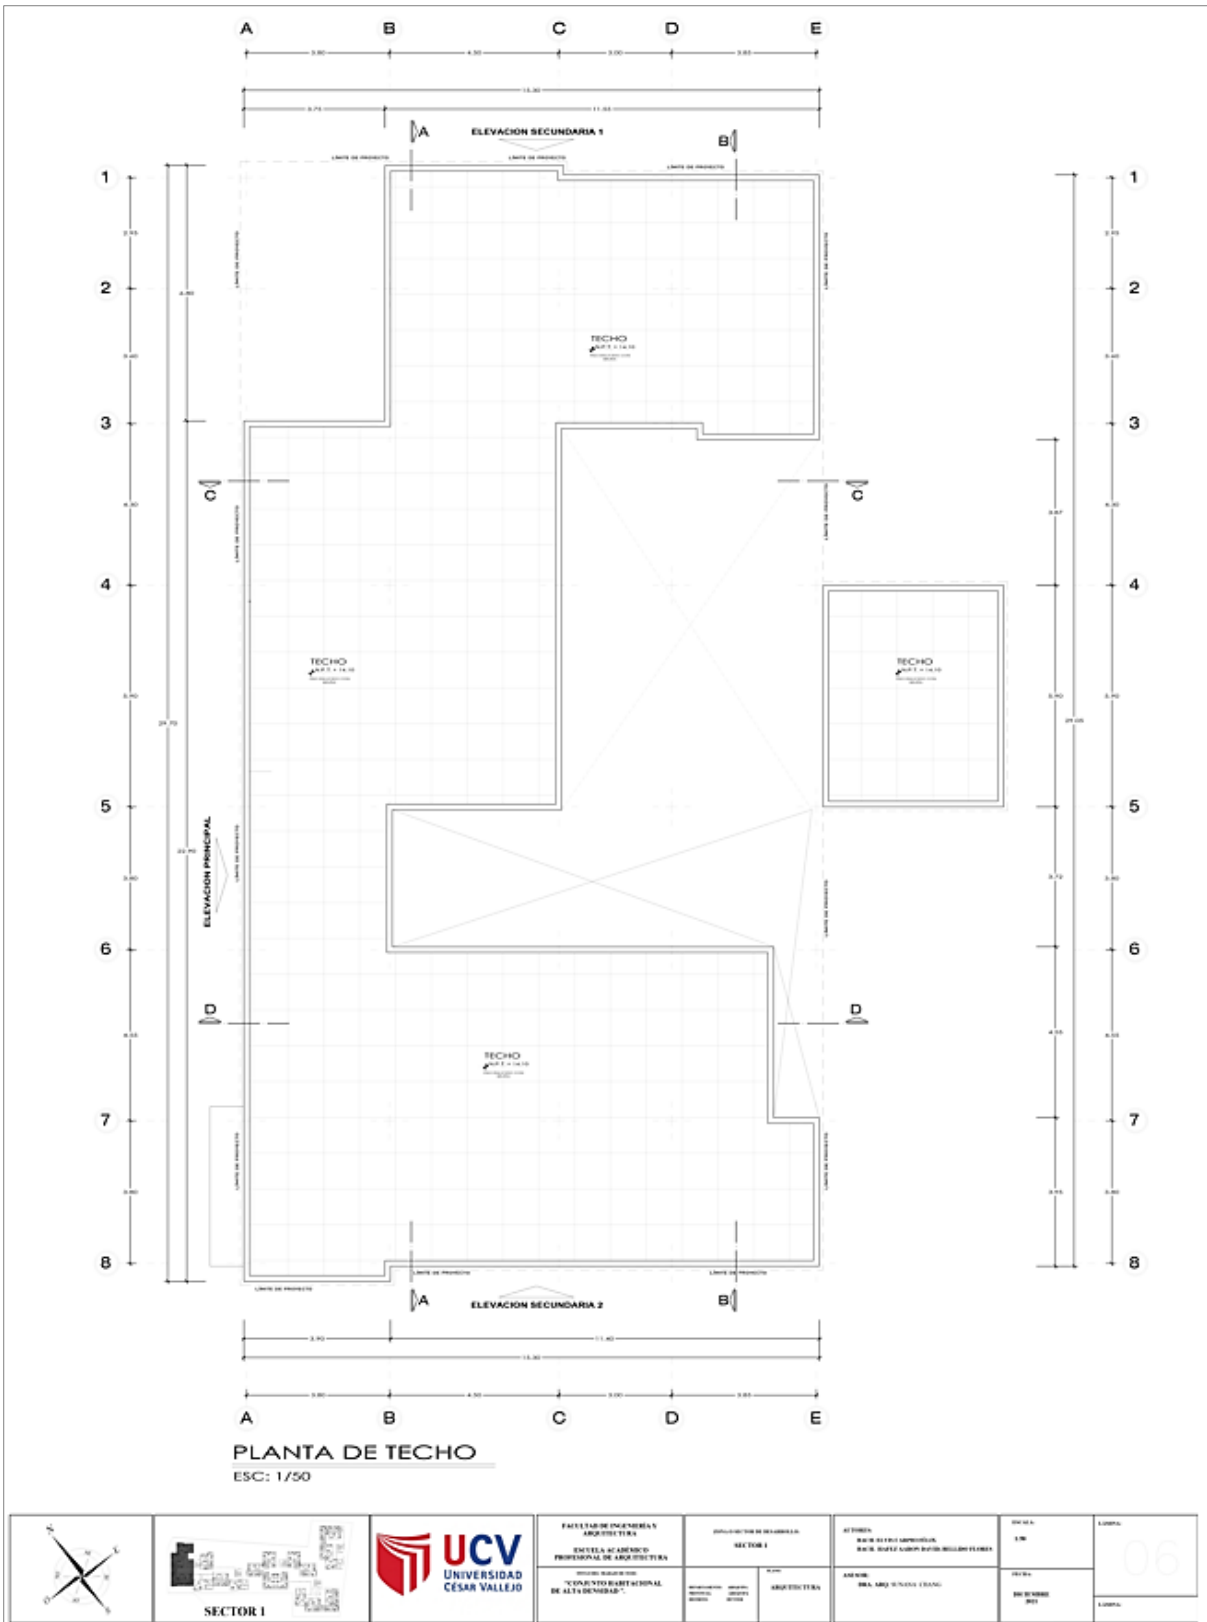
Planos de Arquitectura – 06 - Bloque 1 – Planta de Techos
